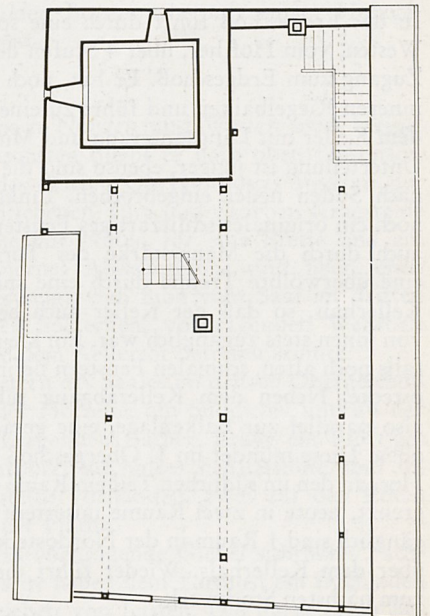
Grundriß vom Dachgeschoß M 1:200, Zustand 1971
